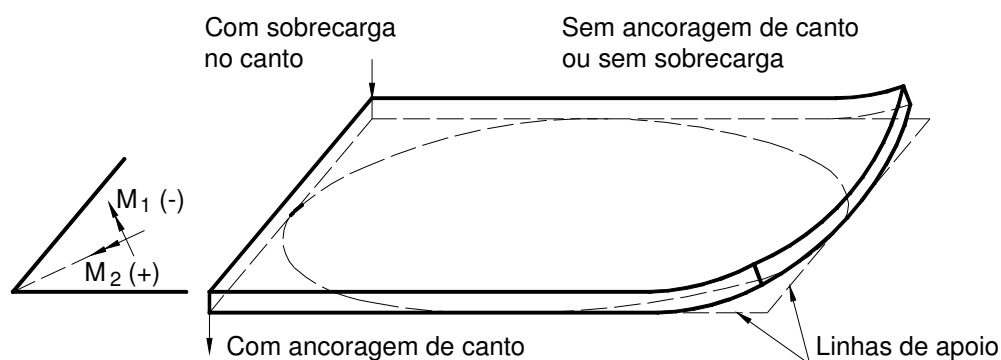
Laje retangular com apoios simples nos quatro lados.
